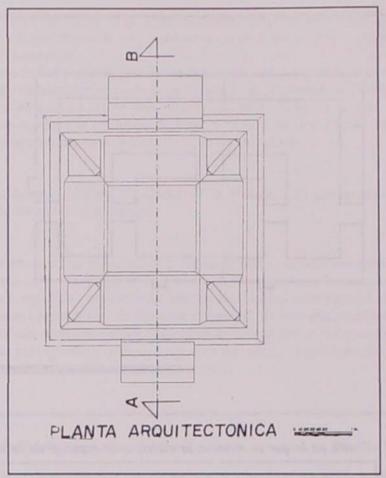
Mediante la planta arquitectónica de la subestructura se distingue el ingenio del constructor que ideó esta obra maestra.
